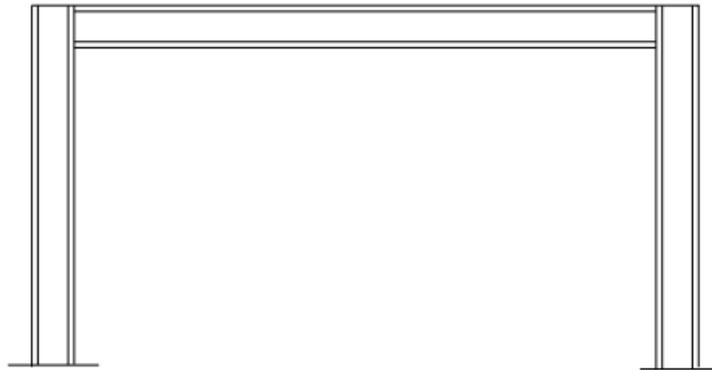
Forma Básica de Estructura de una Sola Planta
